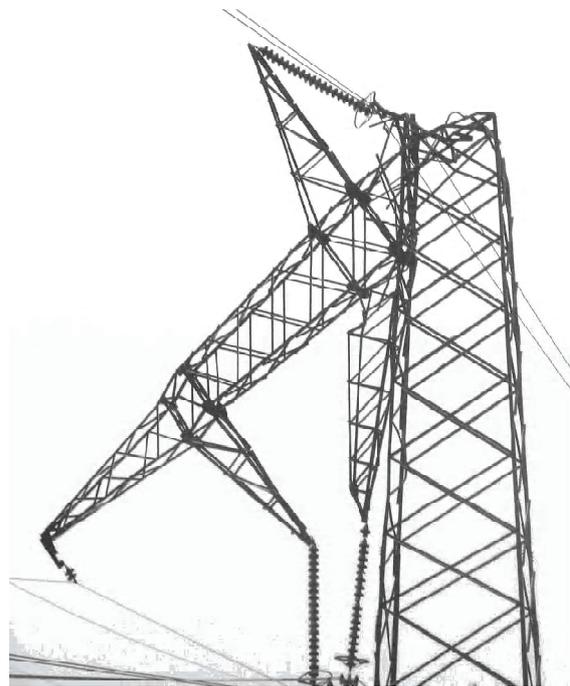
Разрушение металлоконструкций опоры № 195.
